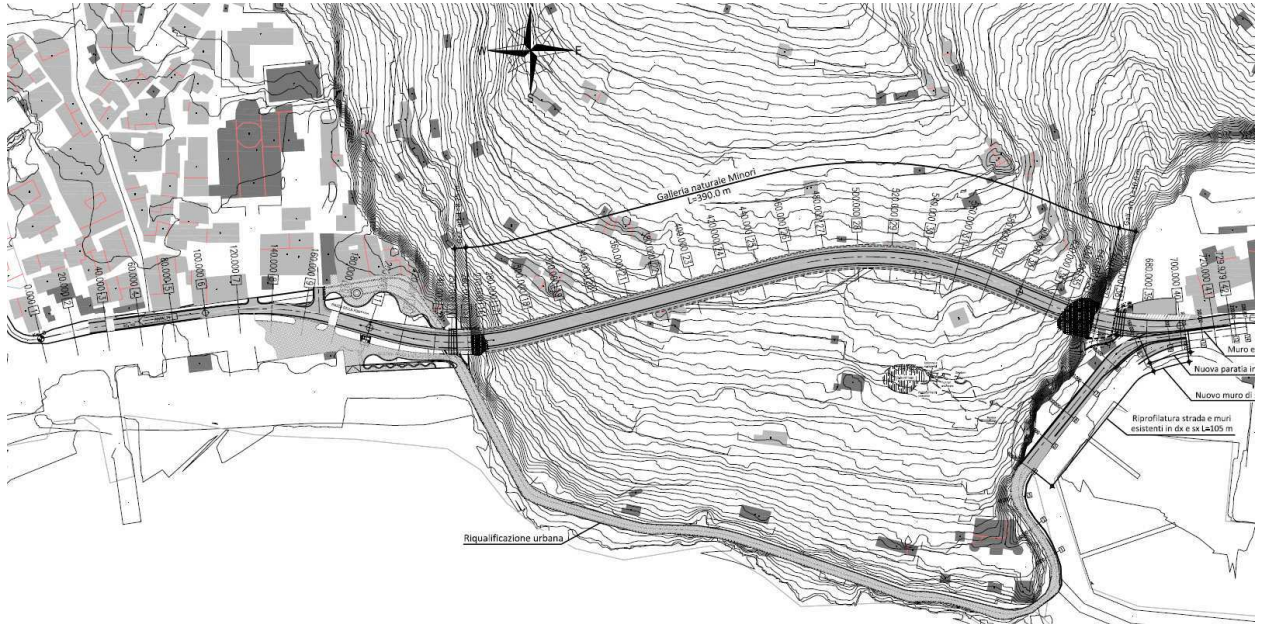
Stralcio planimetria di progetto - T00PS00TRAPP01A
